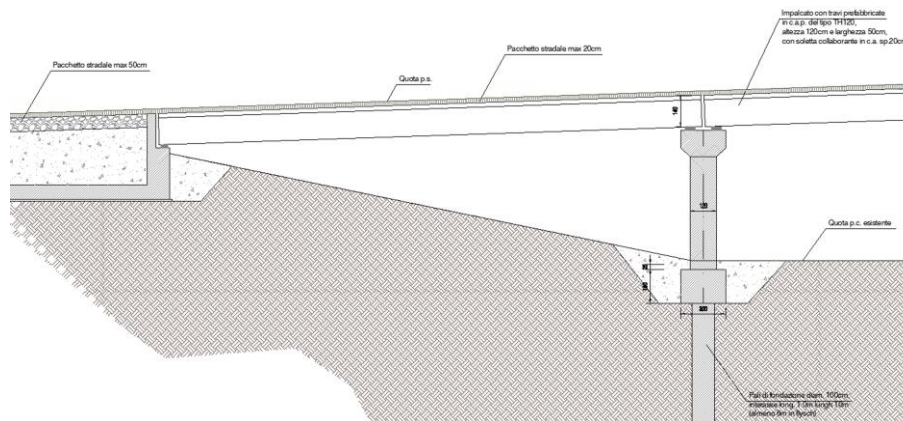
Particolare appoggio impalcato su spalla a terra
